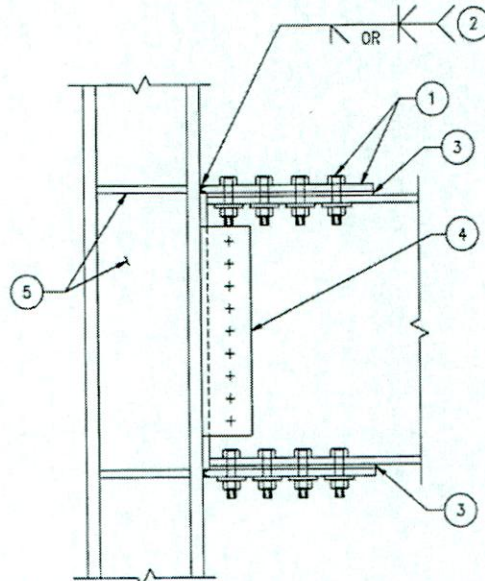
Conexión con Ala Apernada – Plancha Soldada
